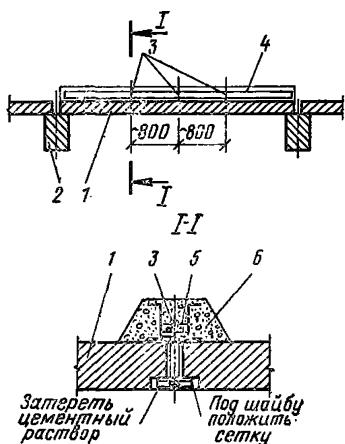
Усиление перекрытия, имеющего прогиб более нормального
